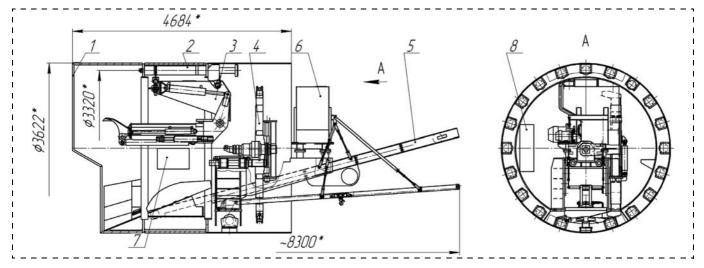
Проходческий щитовой комплекс типа ПЩМ:
